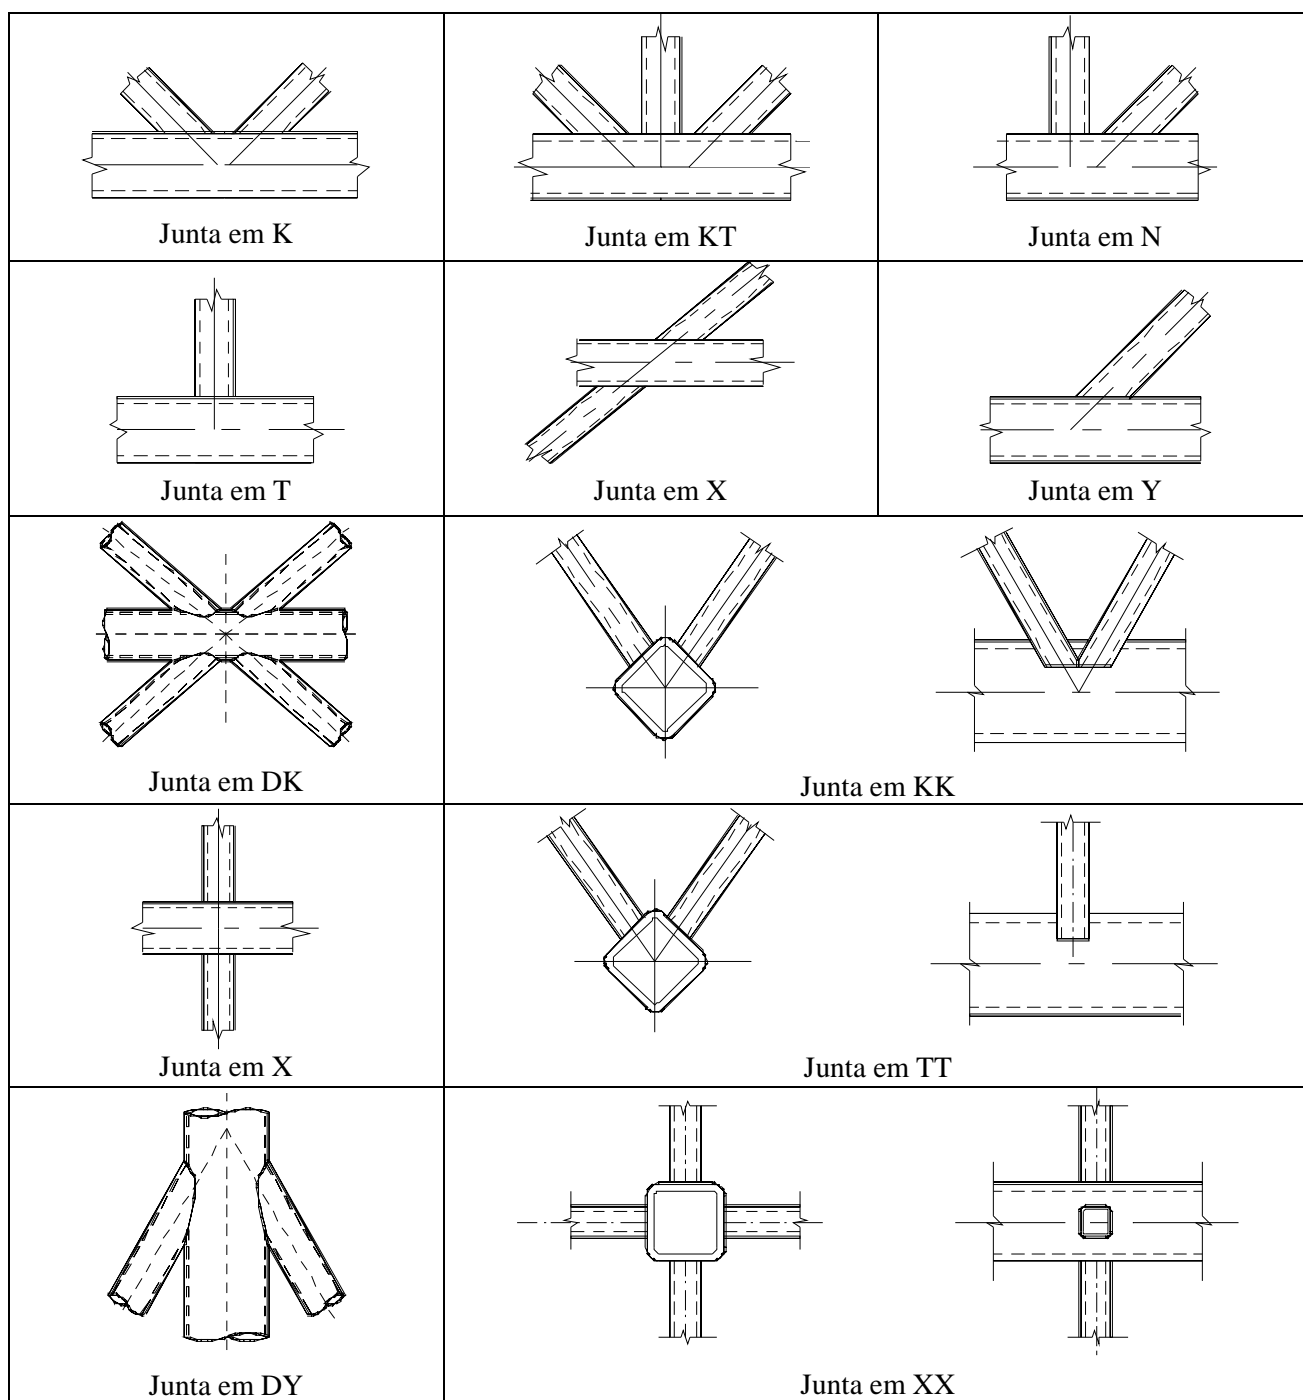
Tipos de juntas em vigas reticuladas de secção tubular
